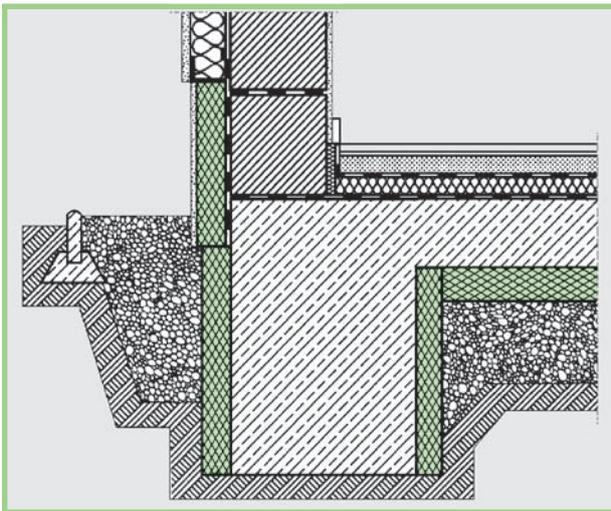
Isolamento delle fondamenta e raccordo al sistema isolante a cappotto esterno.
